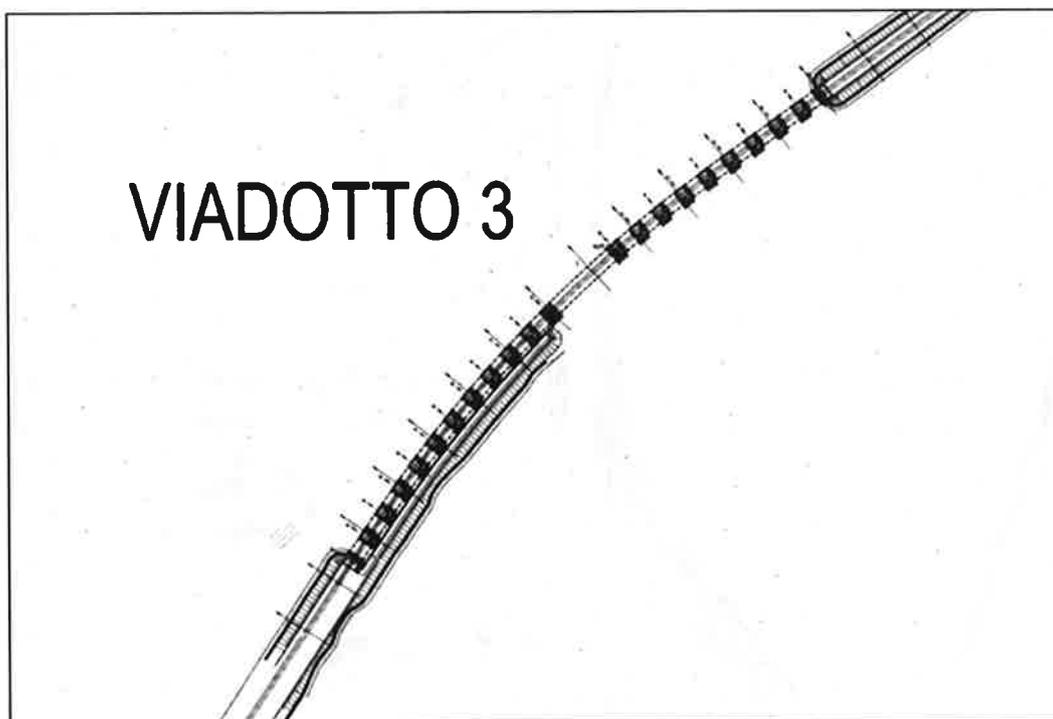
Sviluppo in pianta del viadotto VI01
